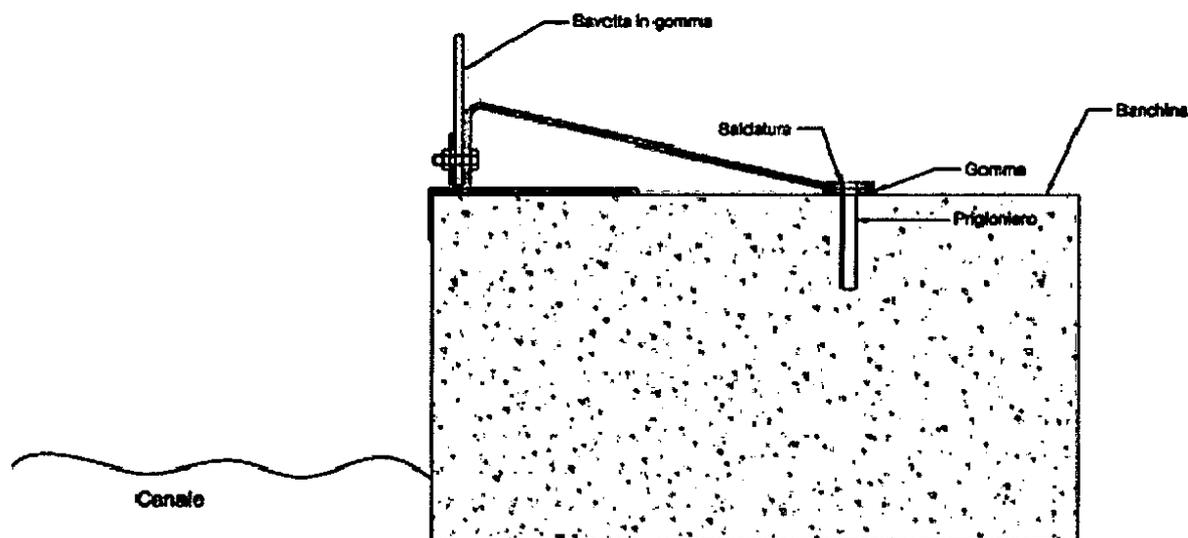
Sezione della barriera di contenimento (completa) installata sul filo banchina
